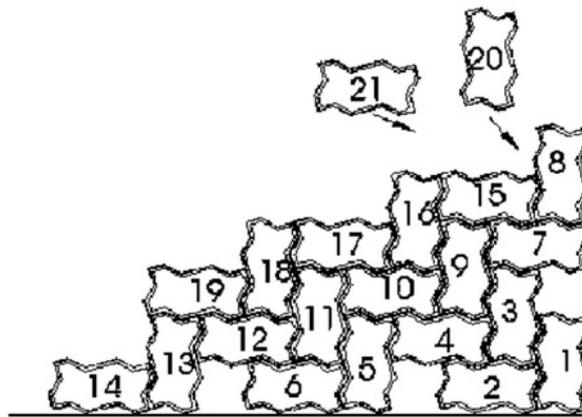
Secuencia de colocación de bloques en un pavimento articulado
